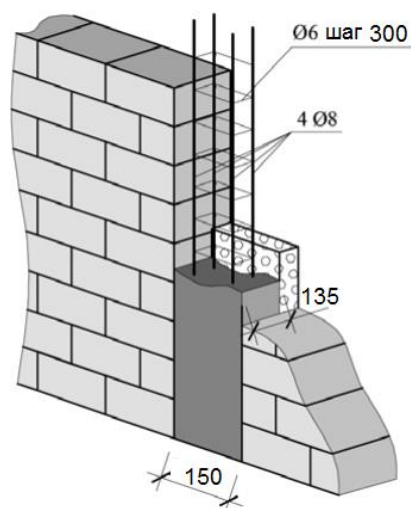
Минимальные размеры поперечных сечений бетона и арматуры железобетонных стоек [10]
